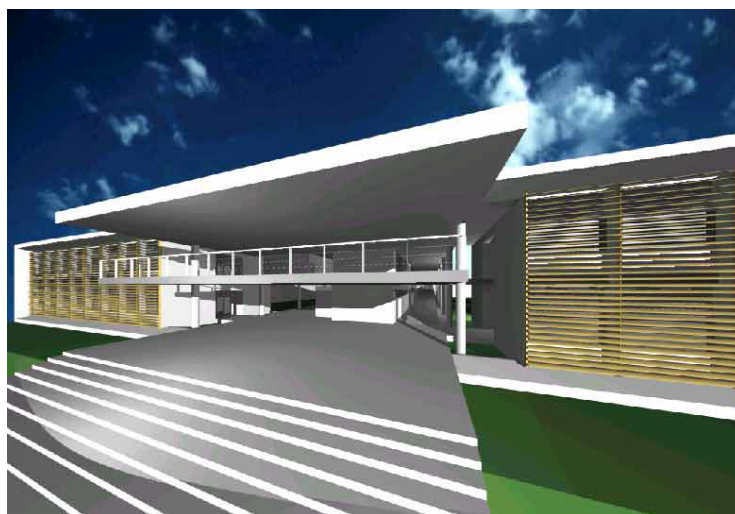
FACE – Maquete eletrônica (Fonte: arquivos de projeto)
